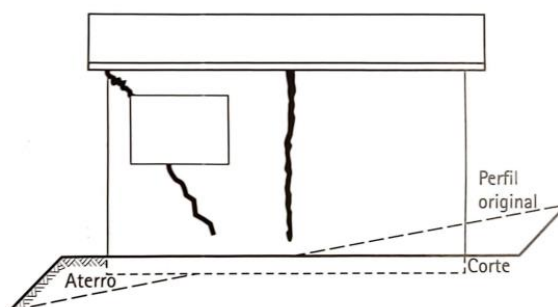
Exemplo de fissuras em corte e parte em aterro (Fonte: Milititsky; Consolini; Schnaid, 2018).
